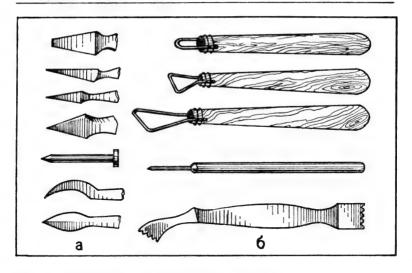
Инструменты для выполнения сграффито: a— резцы; б— скоблилки, стеки
